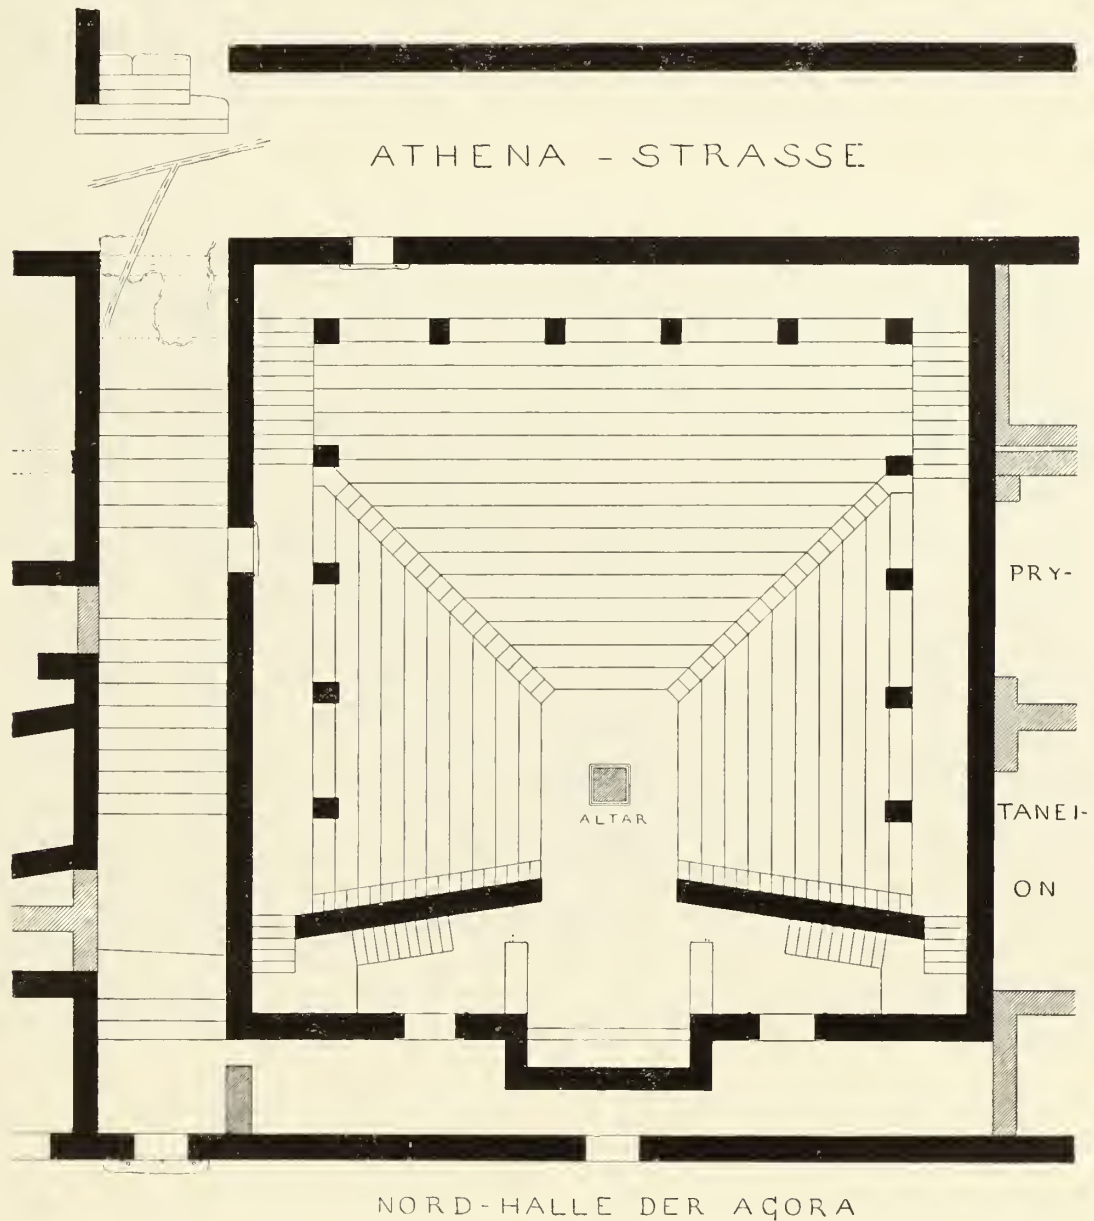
Grundriss des Ekklesiasterion. Rekonstruktion.
